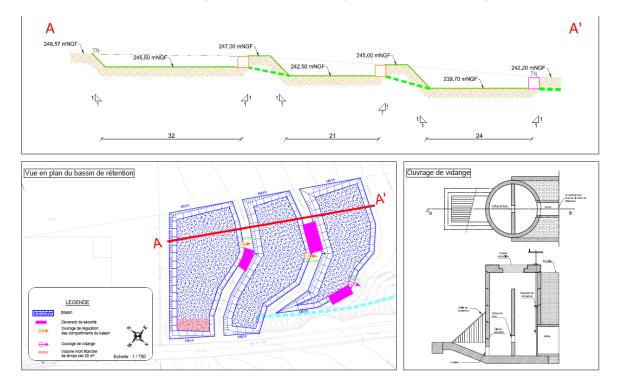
coupe de principe et plan de masse du bassin d'écrêtement
